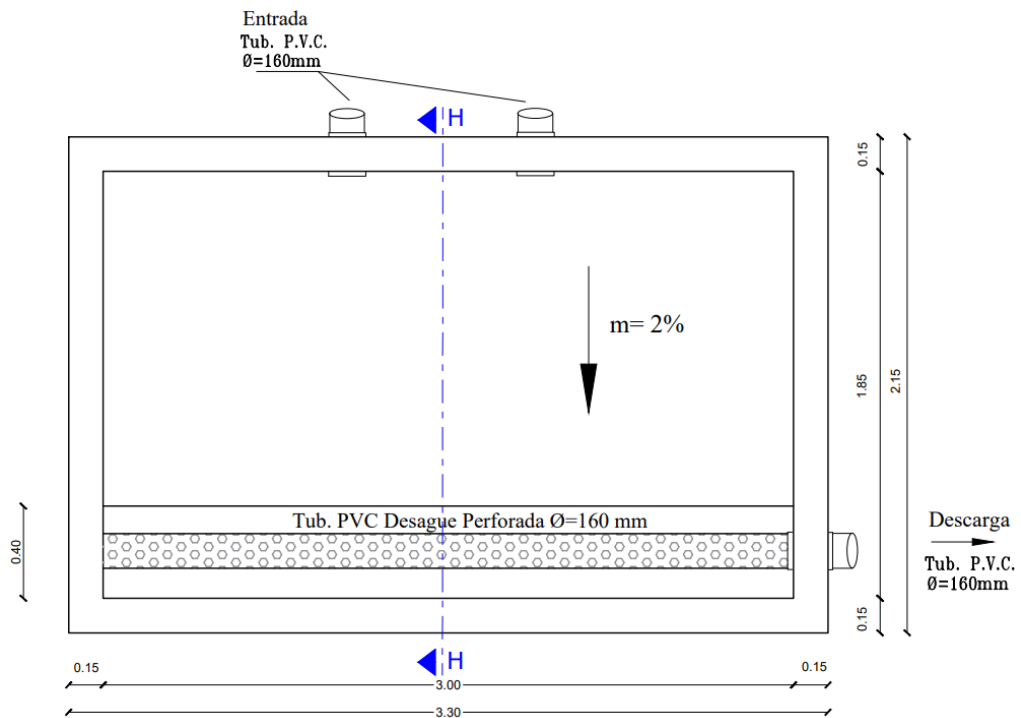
Vista en planta del lecho de secado de lodos rediseñado.
